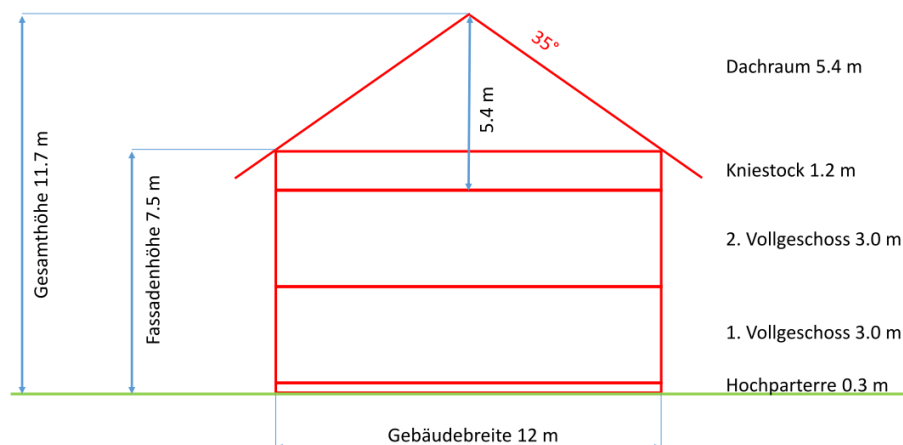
Schrägdachbau Dorfzone mit neuen Höhenmassen
